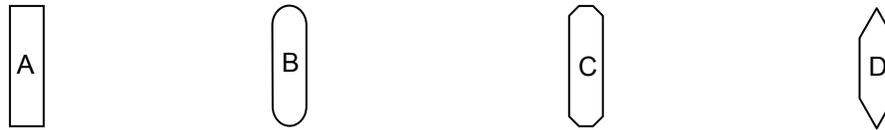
Algunas secciones típicas de pilas de dimensiones menores.
